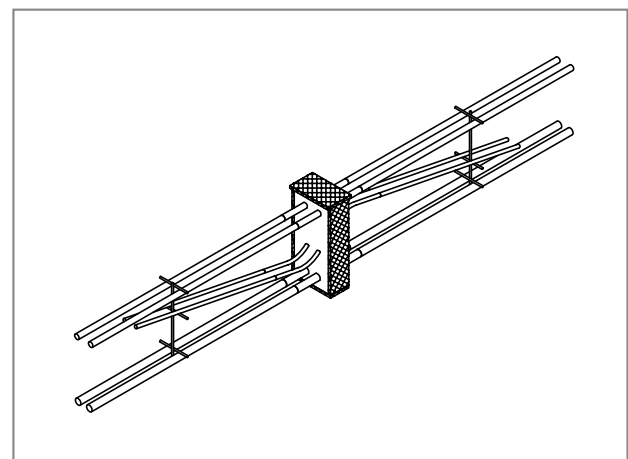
Schöck Isokorb® T Type B : Panneaux de protection incendie sur tout le pourtour
